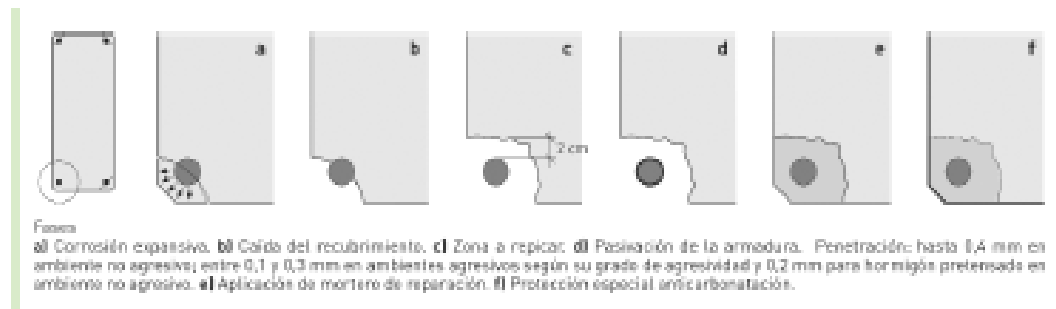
Proceso reparación armaduras. Enciclopedia Broto de patologías de la construcción.
